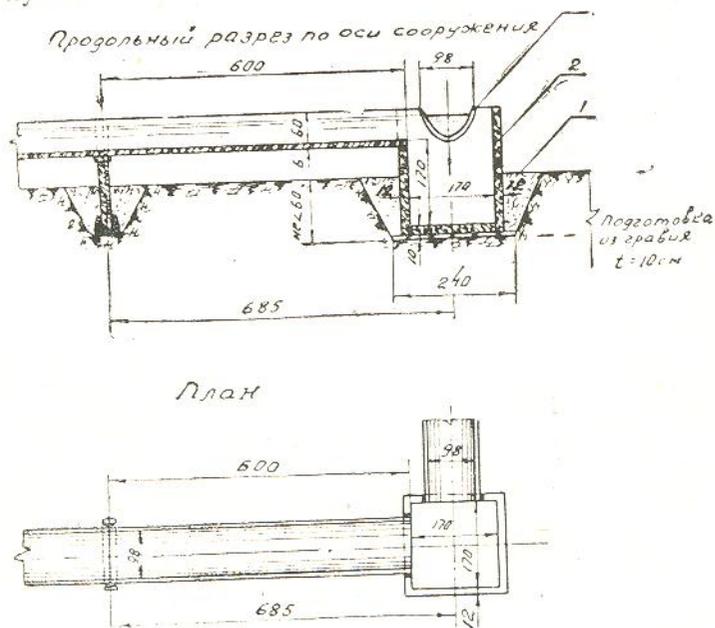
Поворотное сооружение (на 90°) 1— нижний блок; 2— верхний блок; 3— лоток
